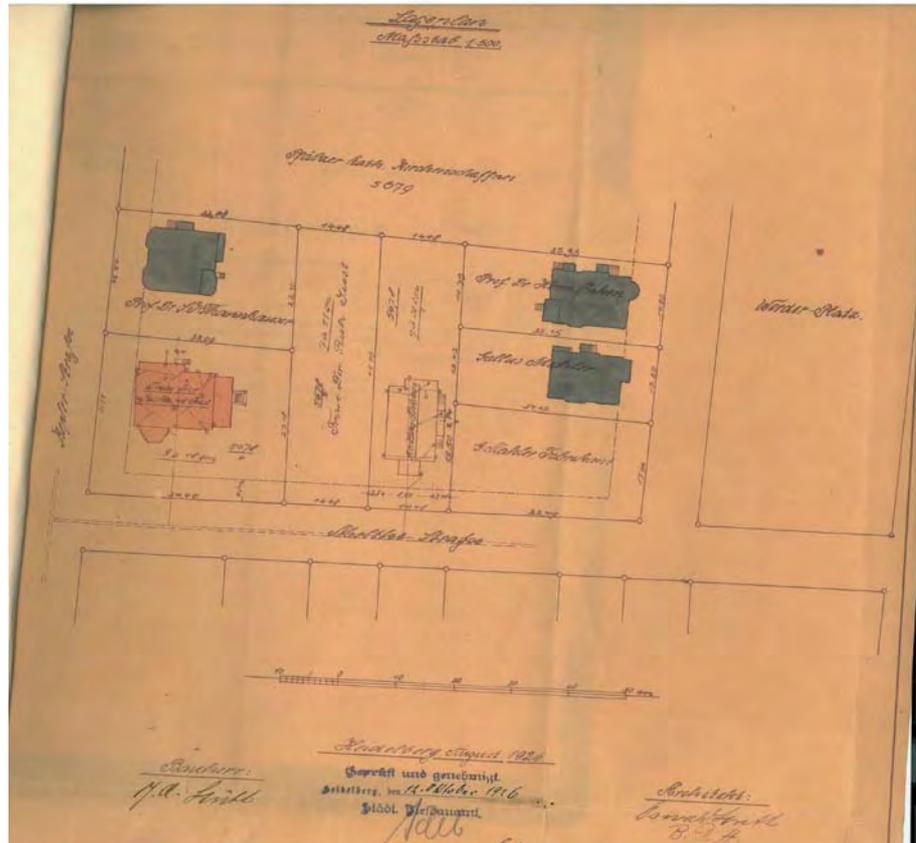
Lageplan Moltkestraße 20 aus dem Jahr 1926 (Registrierung des Amtes für Baurecht und Denkmalschutz Heidelberg), o.M.
